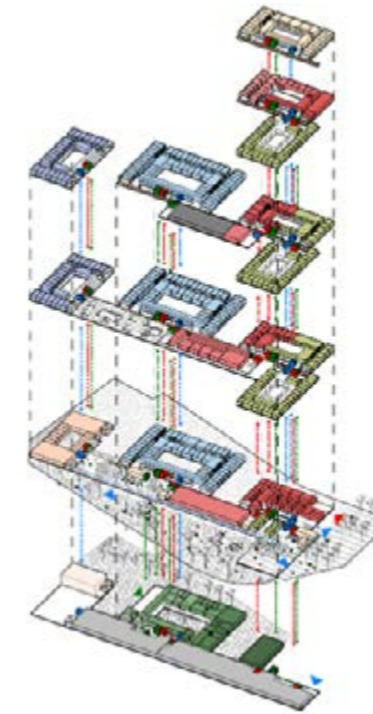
Master plan du site hospitalier Bracops (Source : archipelago architects)
